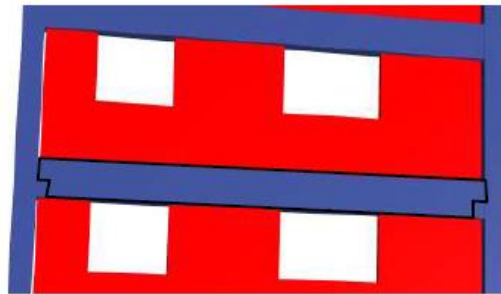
Vigas Principales en su estado operativo. Fase 2
